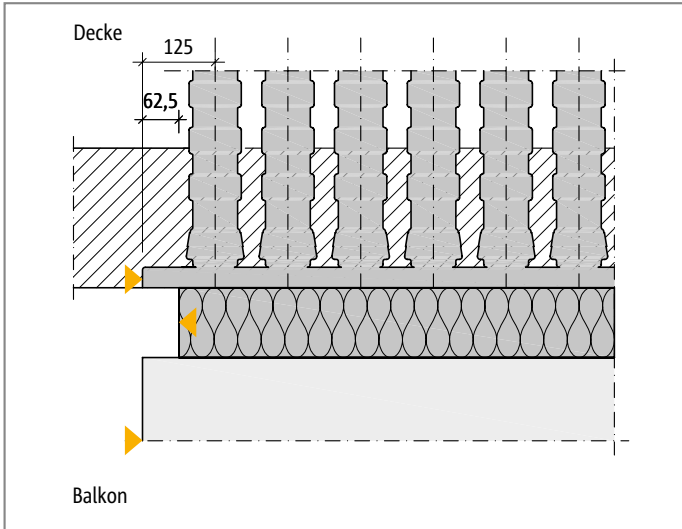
Schöck Isokorb® Typ IDKXT: Randabstand des Dämmkörpers, Achsmaß der Deckenaussparungen
